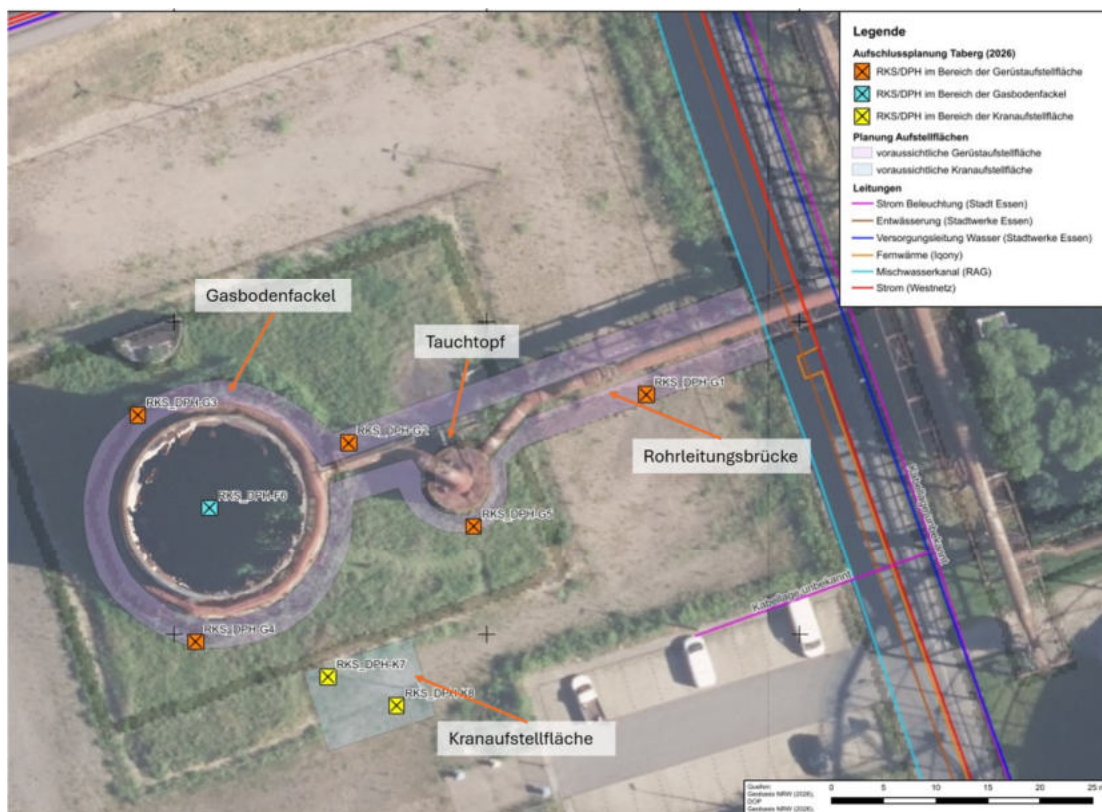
Lageplan mit Darstellung der Rammkernsondierungen
